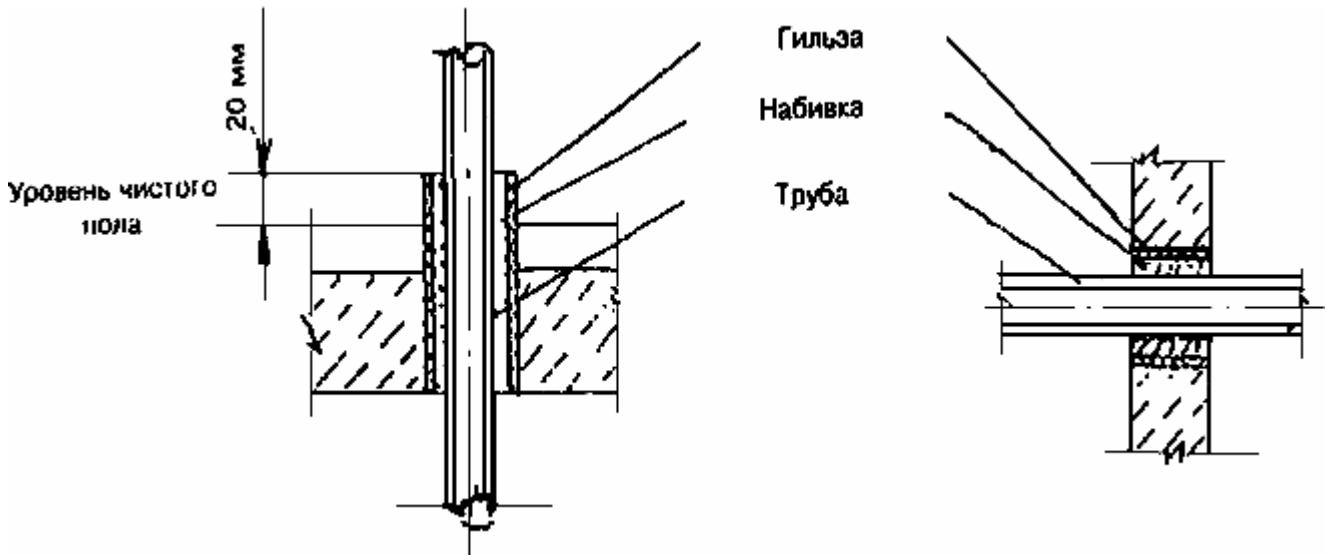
Установка гильзы для прокладки труб в стенах и перекрытиях
